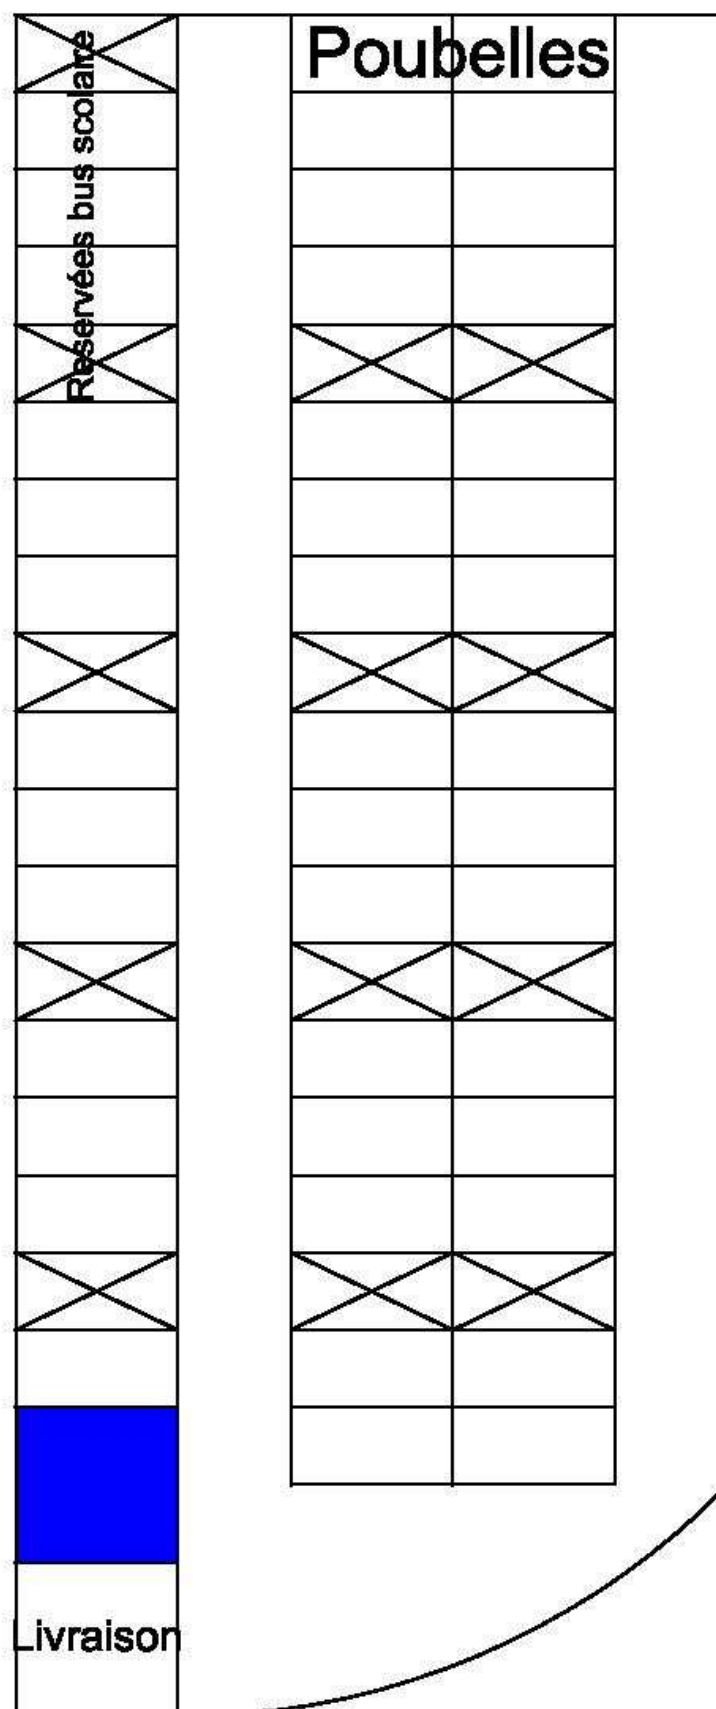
Plan du parking du groupe scolaire (Source : A.Follain)
